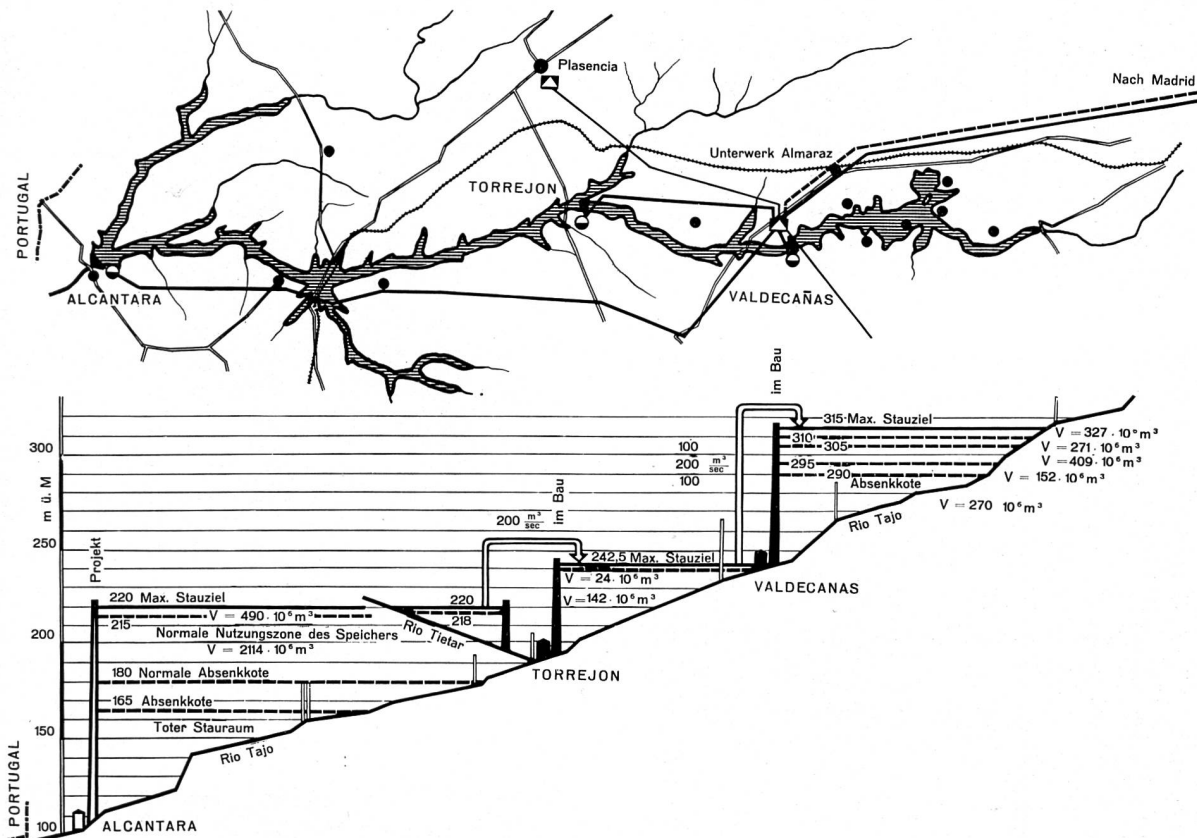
Lageplan und schematisches Längenprofil der Stausee- und Kraftwerkgruppe Valdecañas, Torrejón und Alcántara am mittleren Tajo (Plan aus WEW 1961).
